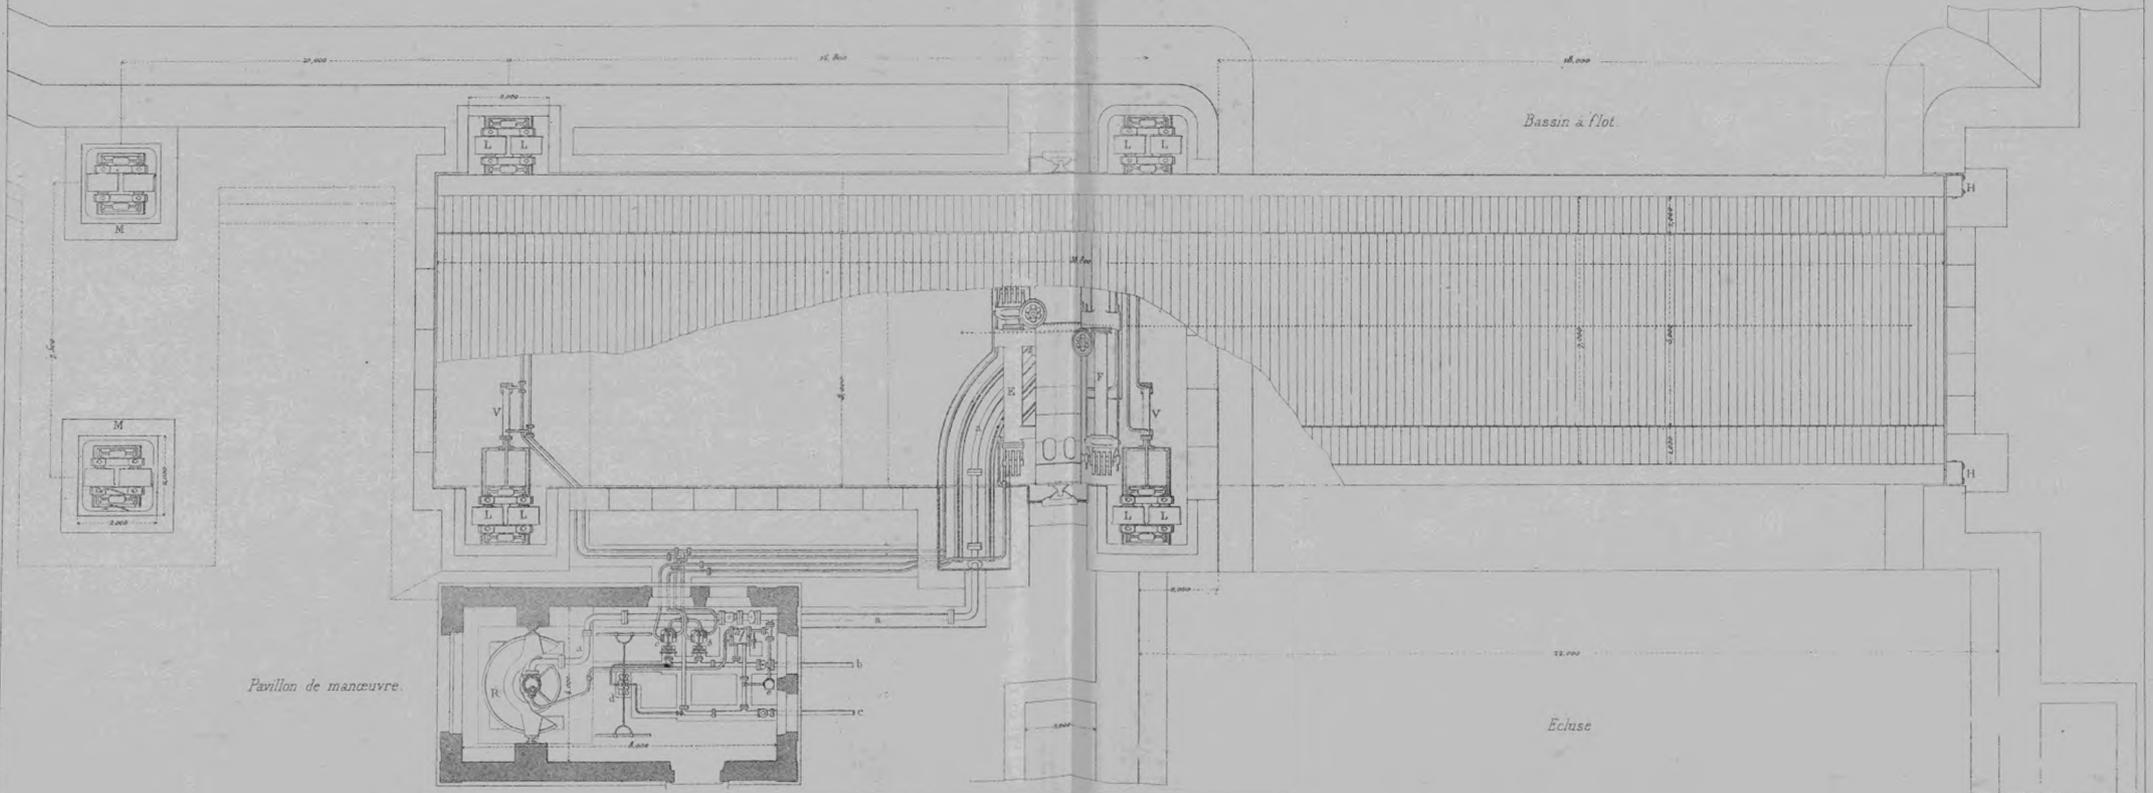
Plan avec arrachement montrant les appareils de manœuvre
